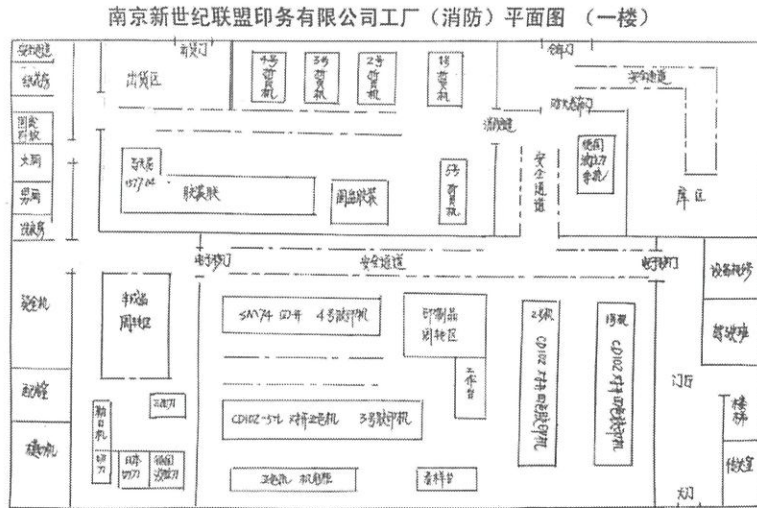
南京新世纪联盟印务有限公司平面布置图
